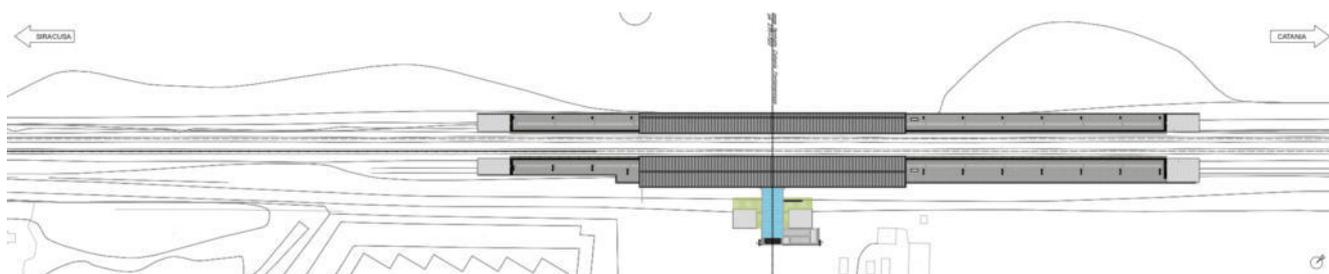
Planimetria generale ante operam - Fermata Fontanarossa
